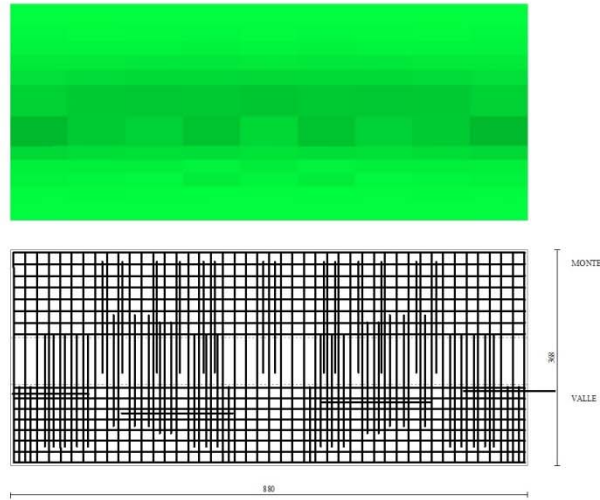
Piastra fondazione dir. Y (Inviluppo)
